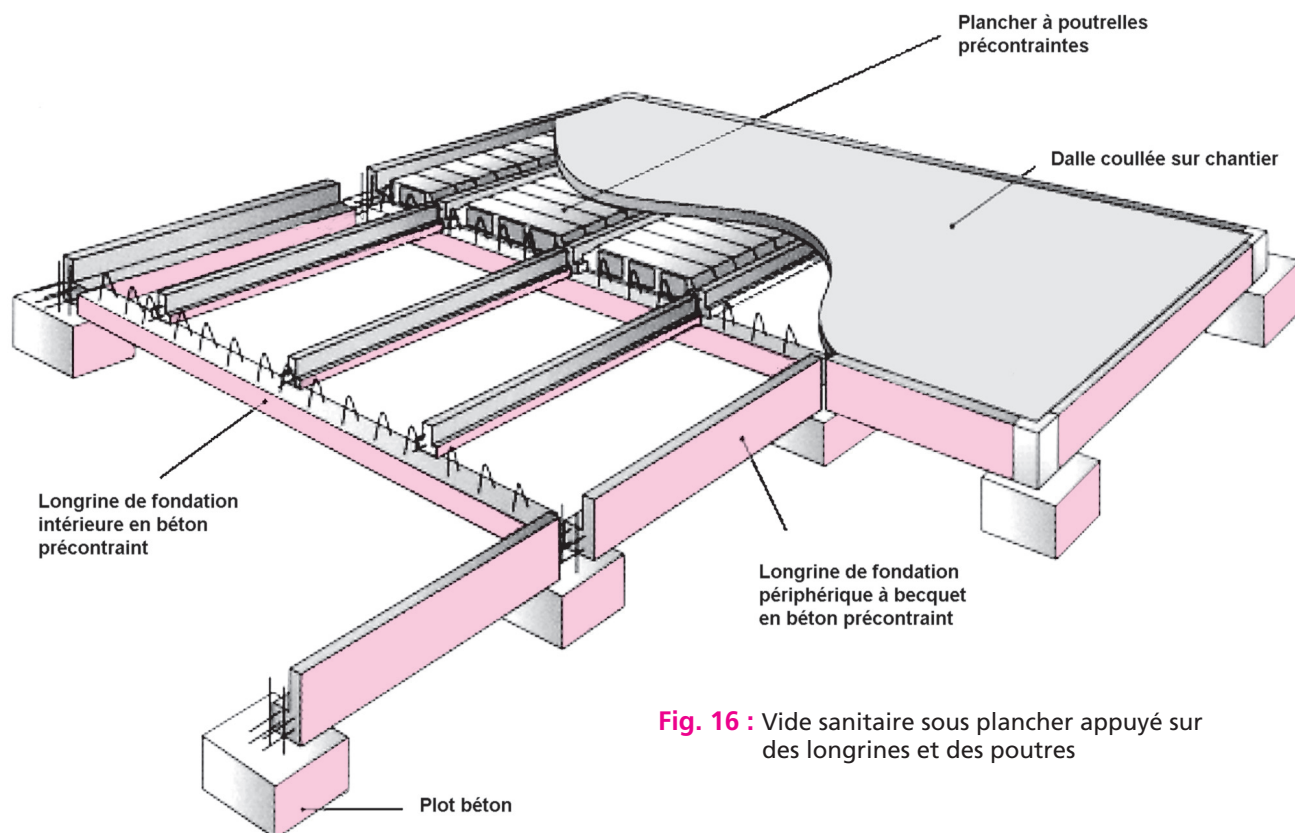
Vitrage sanitaire sous plancher appuyé sur des longrines et des poutres
